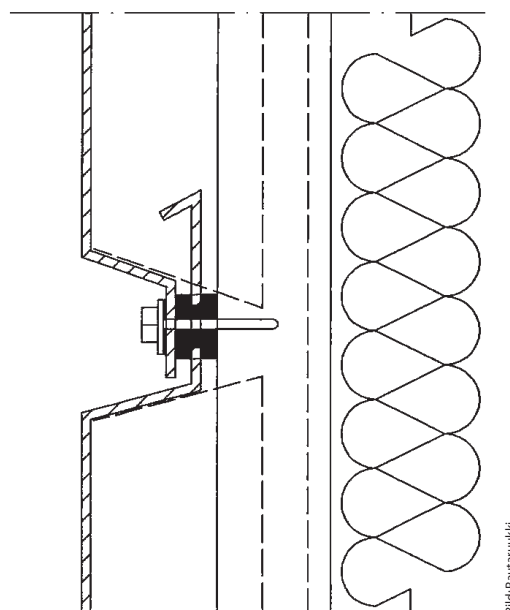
Schraubbefestigung für Kassetten mit wetterfestem Baustahl [4].
